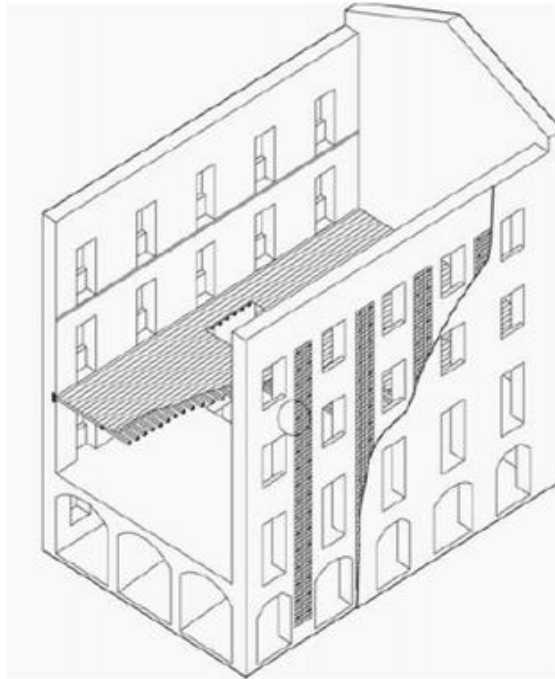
Aplicação de reboco armado a uma fachada de um edifício de alvenaria (Cóias, 2007)
